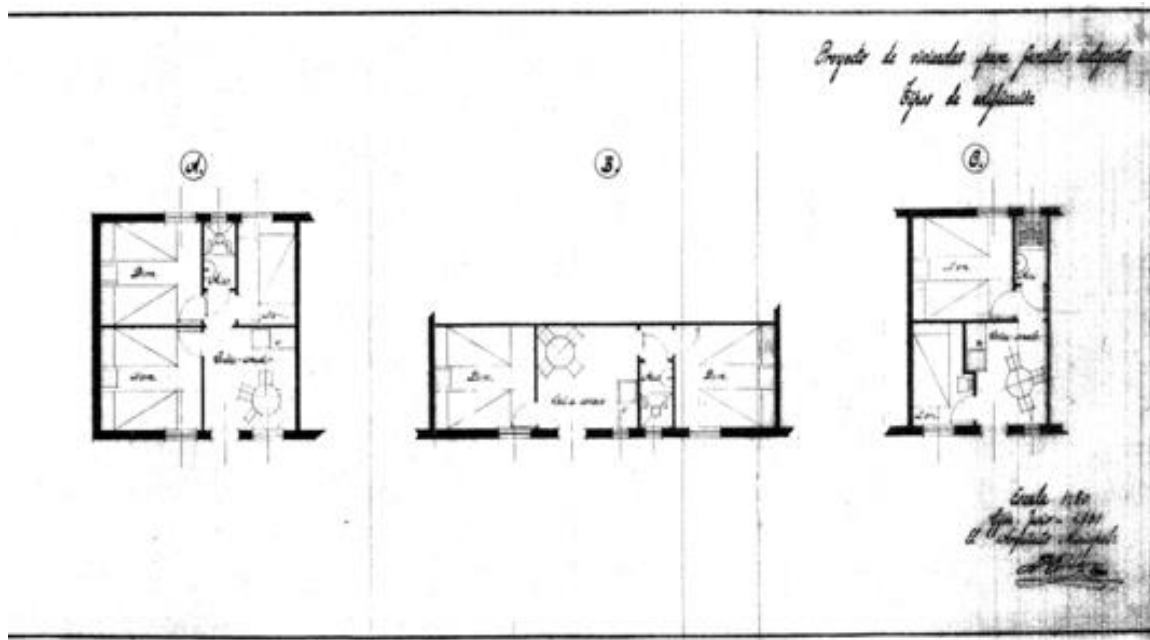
Plantas de viviendas de tipo A, B y C para el barrio de El Llano. AGA, caja 26/16024.
